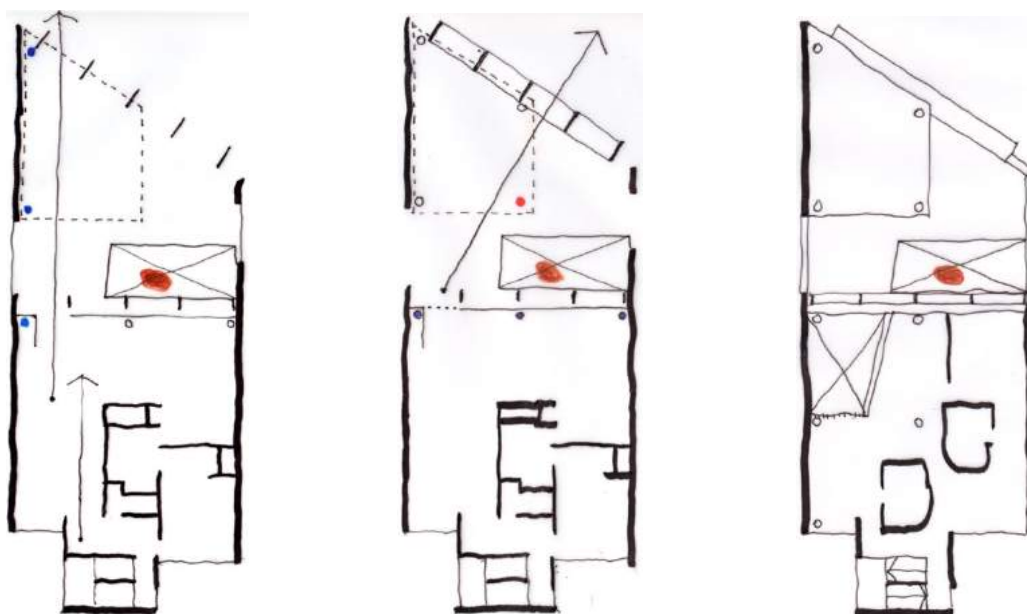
Au centre et au milieu : plan du 2^e étage. À droite : plan du 3^e étage.
